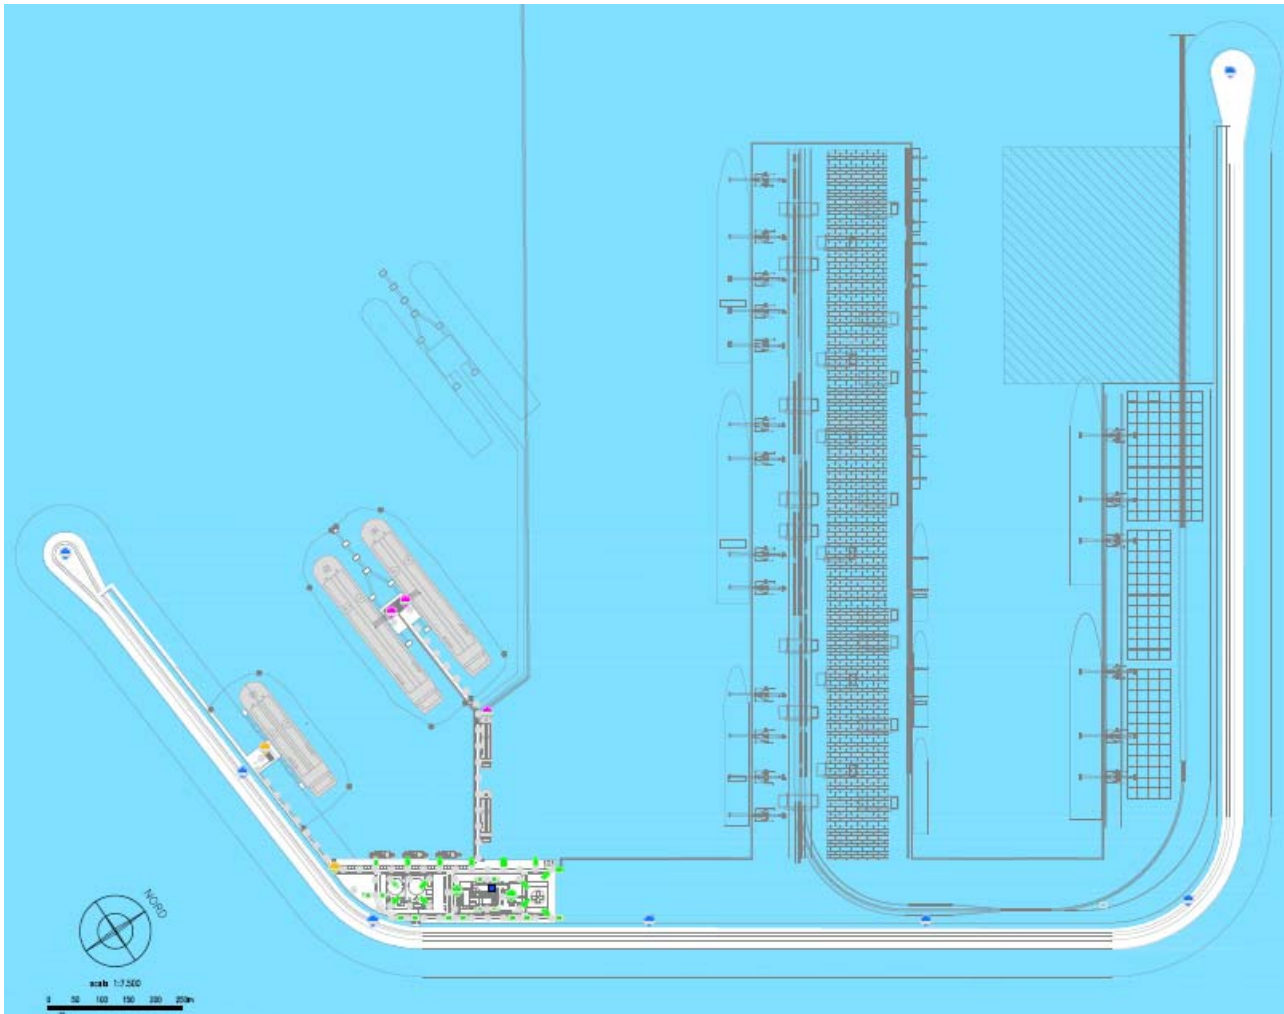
Planimetria distribuzione impianto TV/CC sul terminal plurimodale
